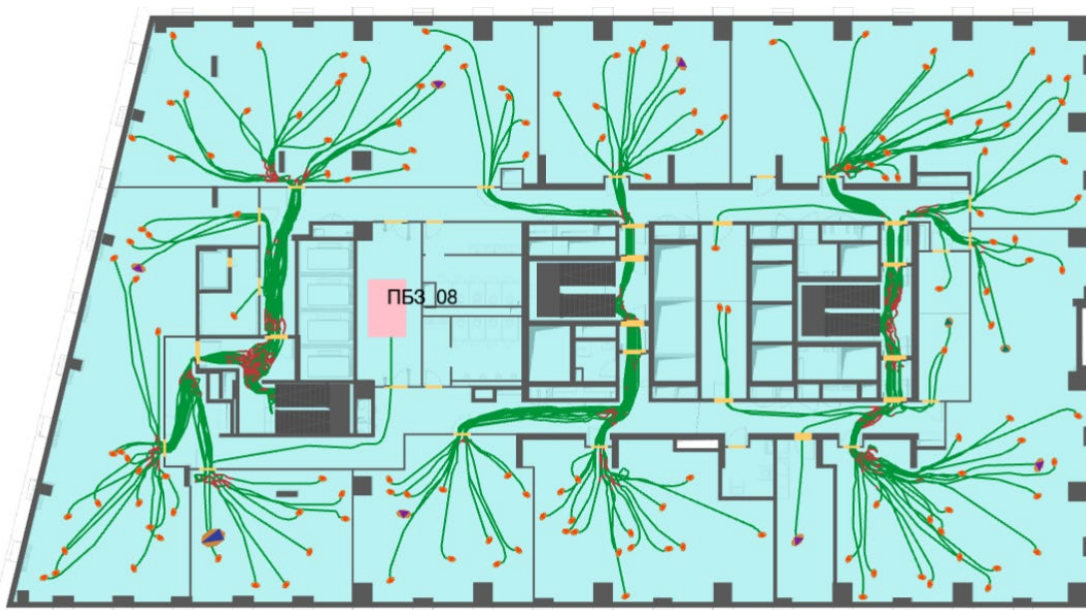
План 8-го этажа и нанесенная на него расчетная (принципиальная) схема эвакуации
